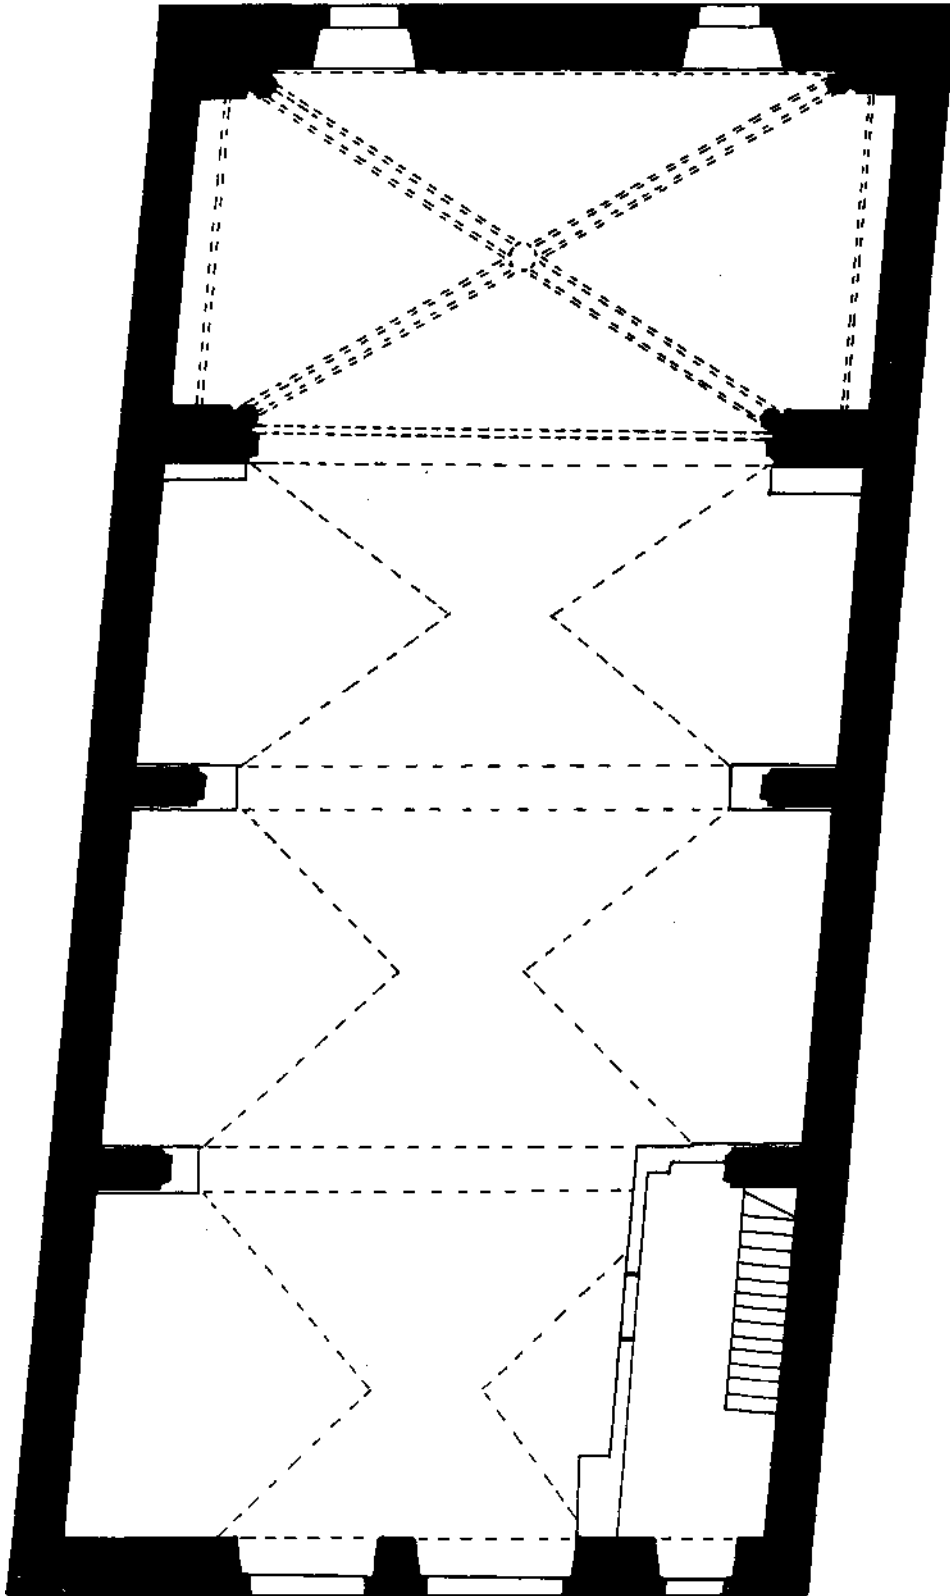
Planta baja (J. Joaquín Roncal Baráibar).
